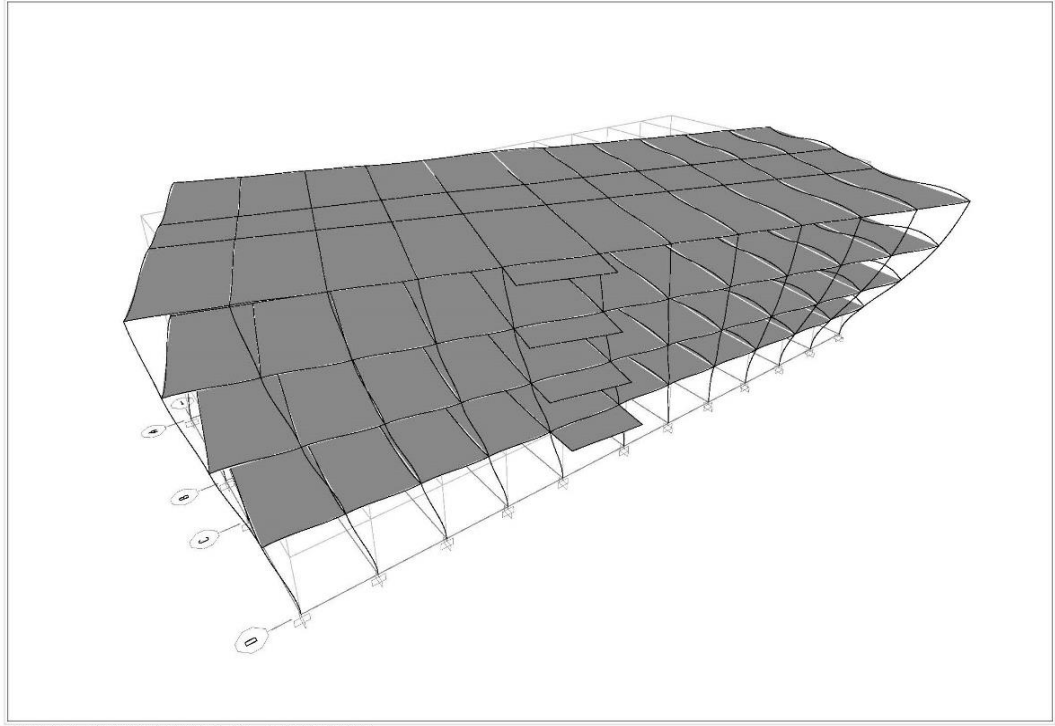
Tipik bir plan üzerinde “Q” yüklemesi.
